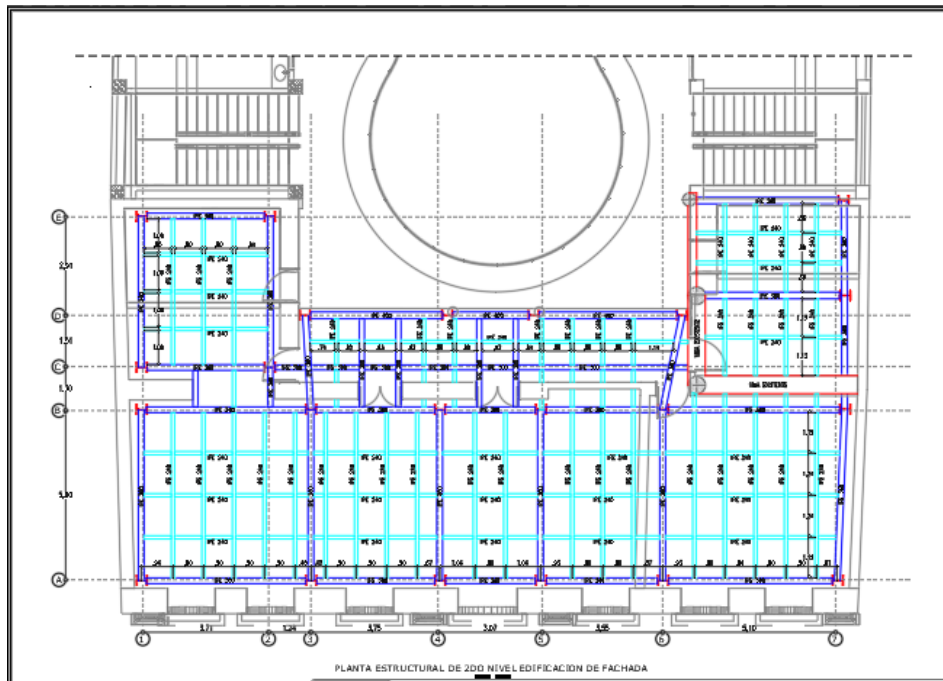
Planta de entre piso. . Fuente. Ing. Alvaro Caballero
